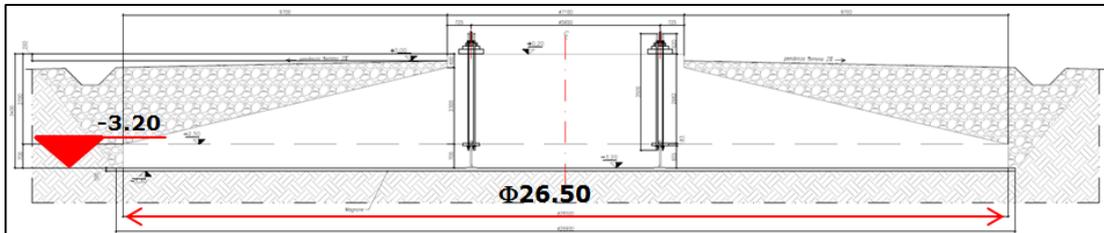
Sezione tipica di sezione stradale con condotta di attraversamento.
